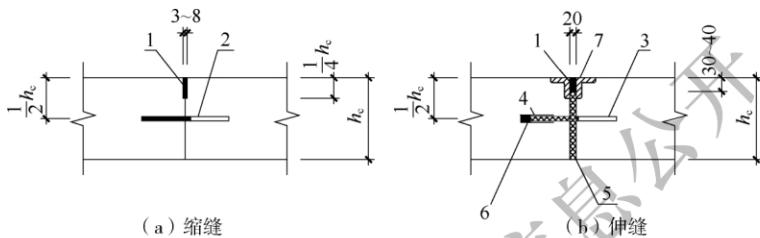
钢筋混凝土缩缝和伸缝构造
